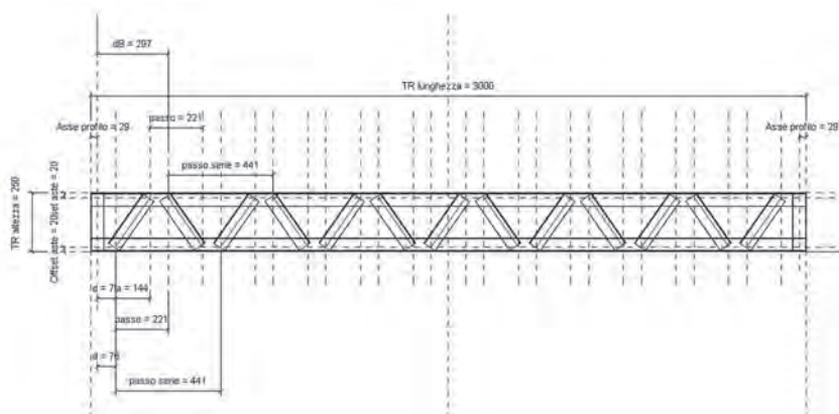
Parametrizzazione geometrica della trave reticolare. Autore Lewis Dal Magro.
